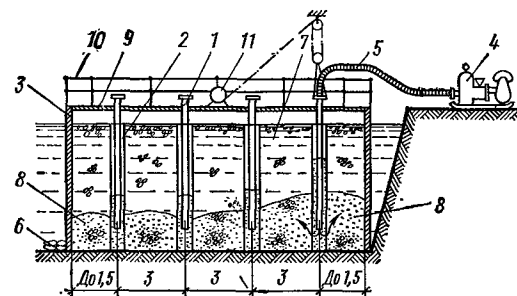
Подводное бетонирование методом восходящего раствора (ВР):
